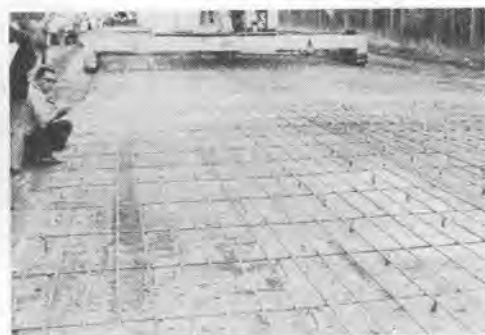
連続鉄筋コンクリートの現場 (ミズリー州)
